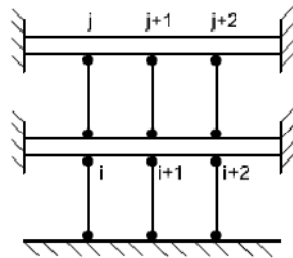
Estructura del sistema de cimbrado previa al descimbrado de la planta inferior.
